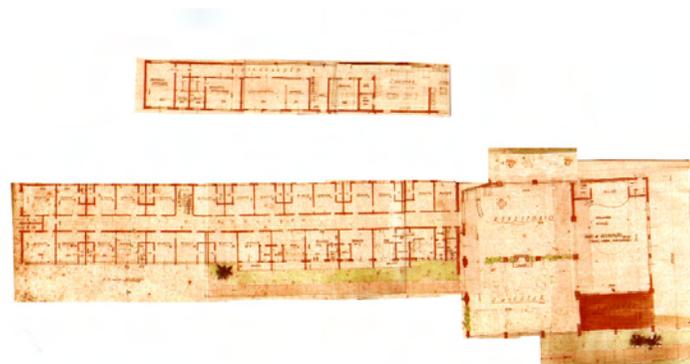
Planta atual do edifício Hotel Águas de Santa Clara. : cópia do projeto cedido pelo autor.
